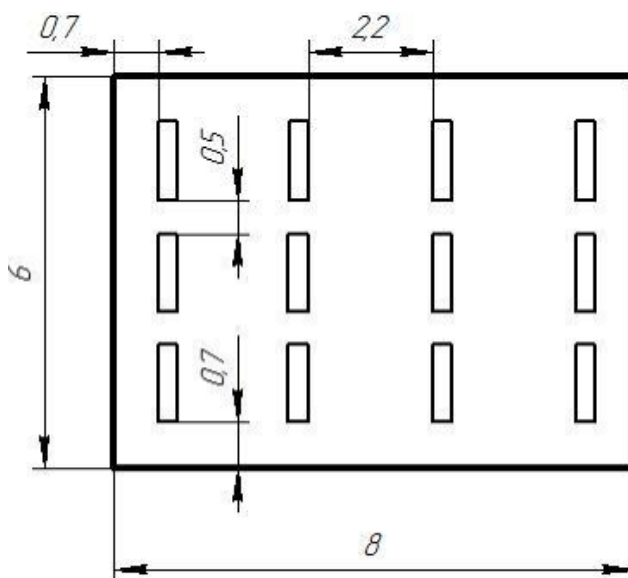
План помещения и размещения светильников с люминесцентными лампами
